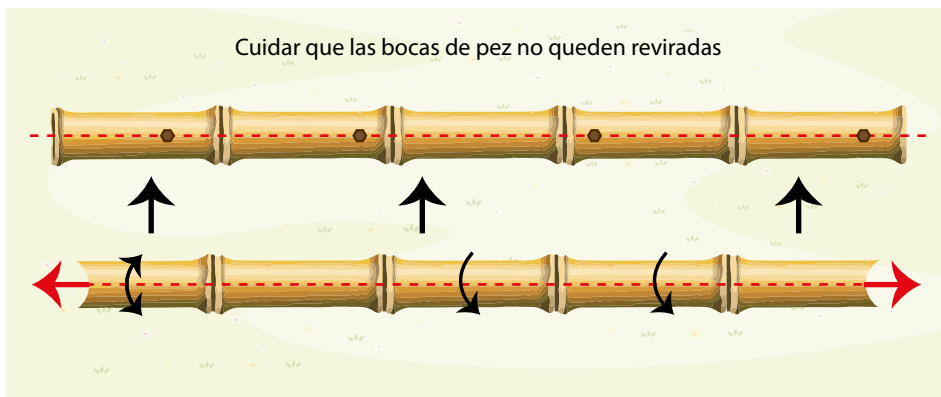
Colocación de vigas, no reviradas las boca de pez.
